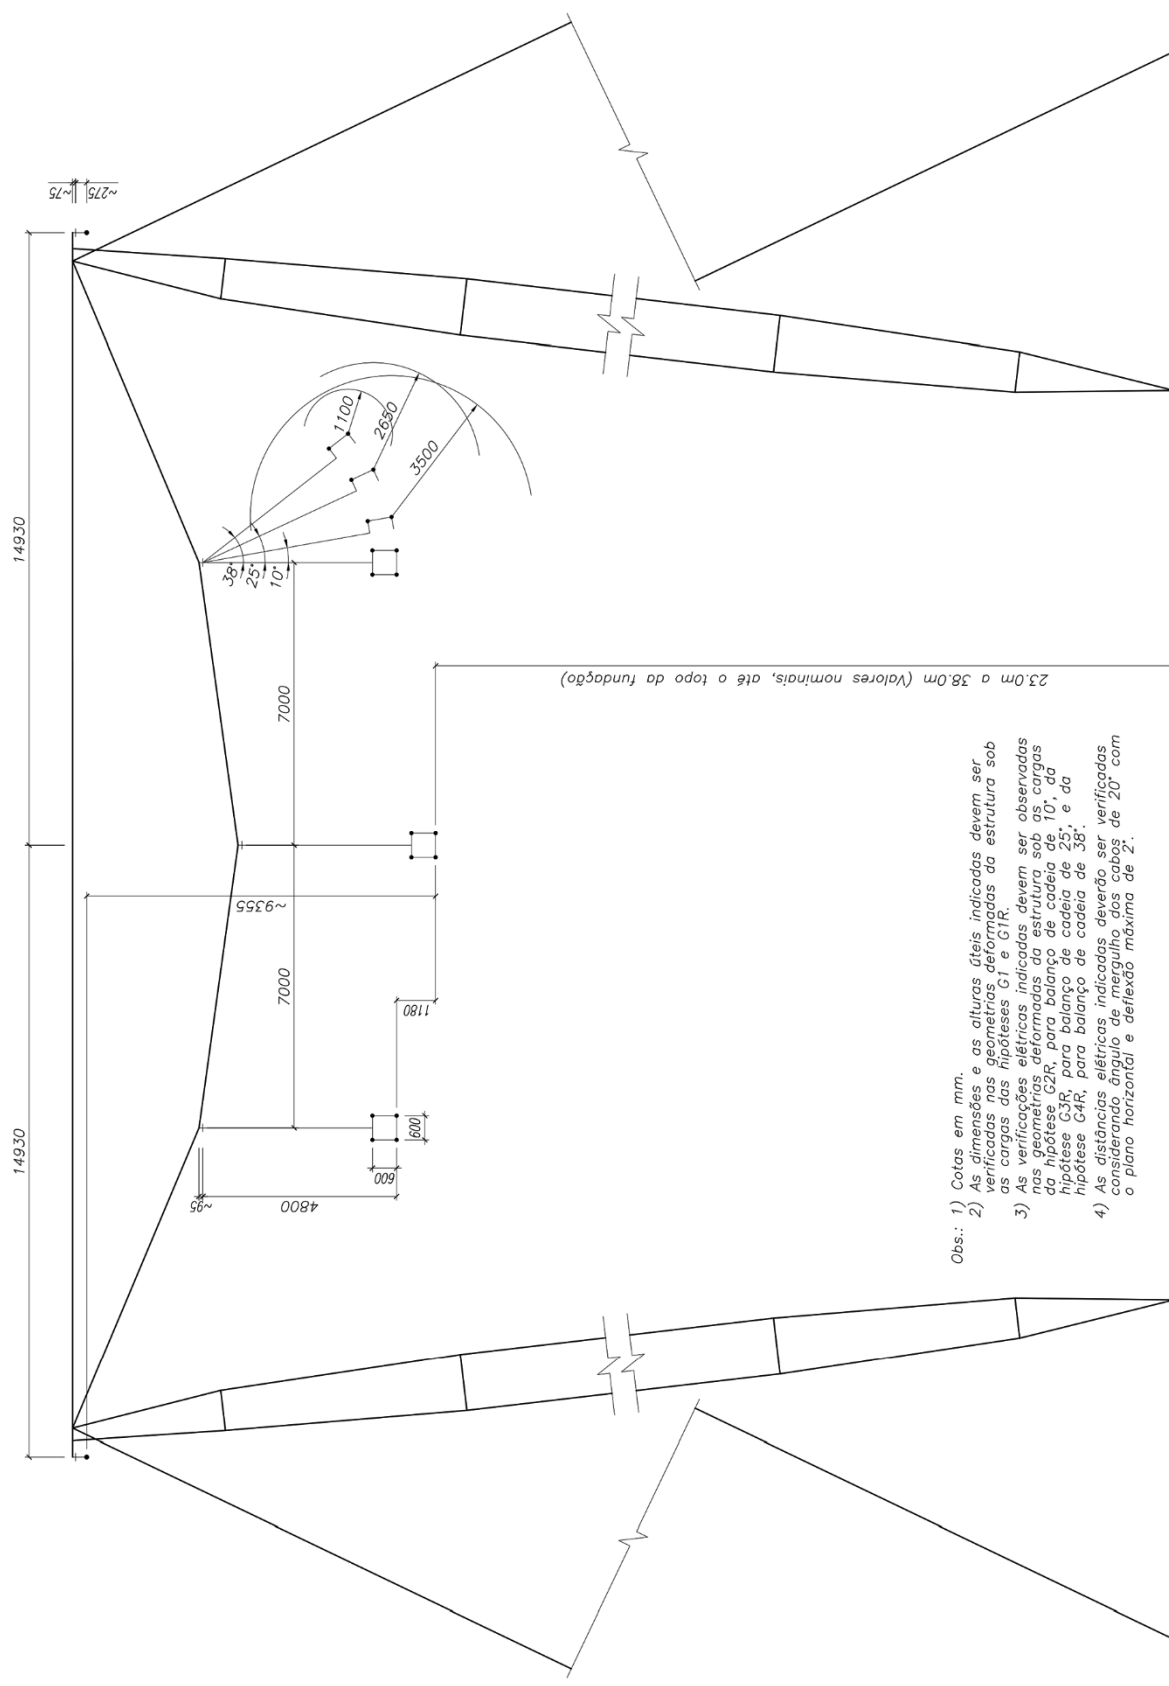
Silhueta de torre estaiada cross-rope de suspensão Leve – CLJ5.
